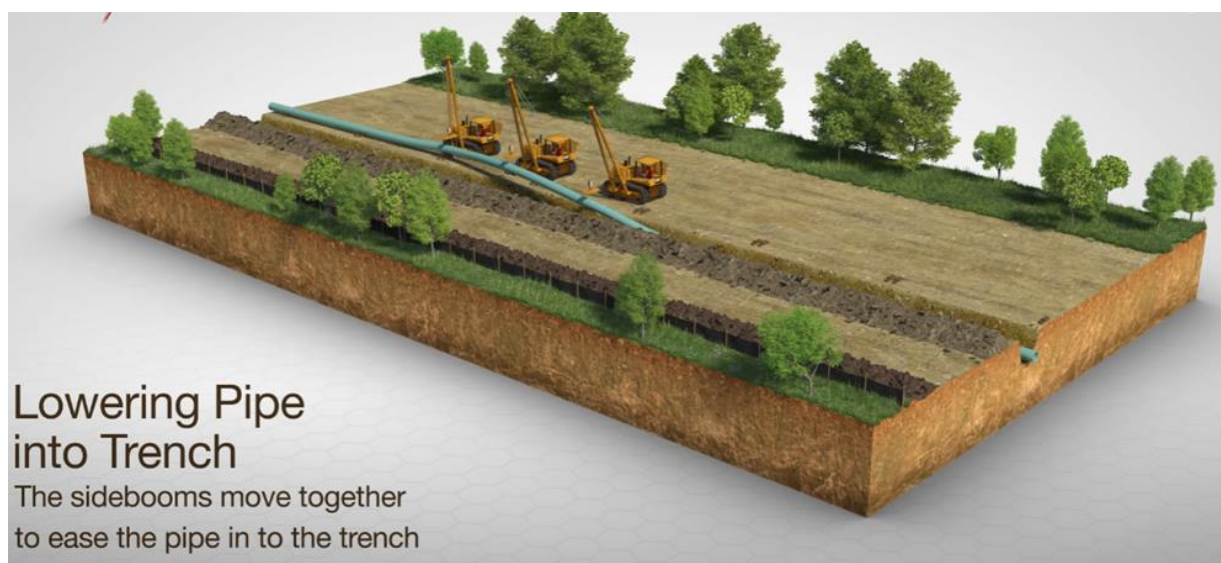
Werkstrookindeling voor aanlegmethode warmteleidingen in open ontgraving
